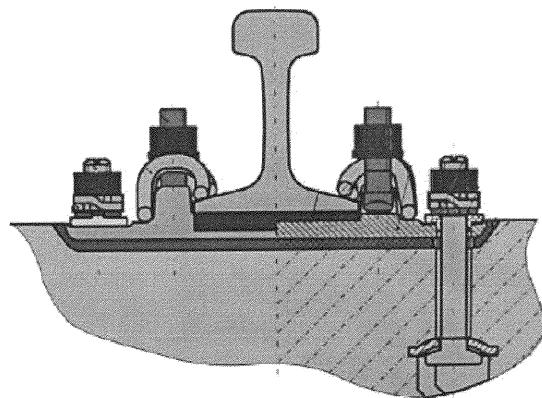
Упругое раздельное рельсовое скрепление с прутковыми торсионными клеммами для железобетонных шпал (рельсовые подкладки закреплены анкерными болтами к шпале, клеммы затянуты с помощью клеммных болтов, установленных на подкладке)
